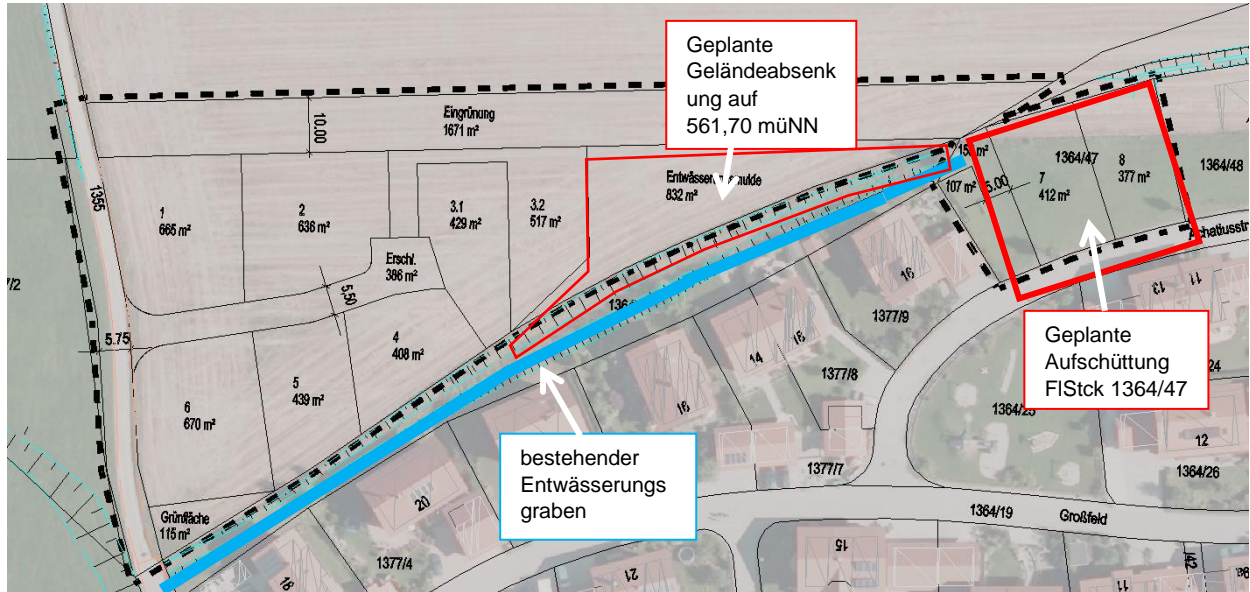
Lage bestehender und geplanter Retentionsflächen
